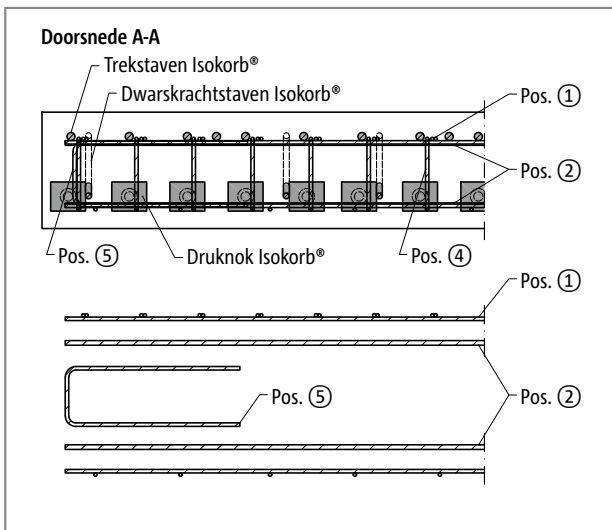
Schöck Isokorb® T type K-M12: Bijlegwapening bij directe ondersteuning
